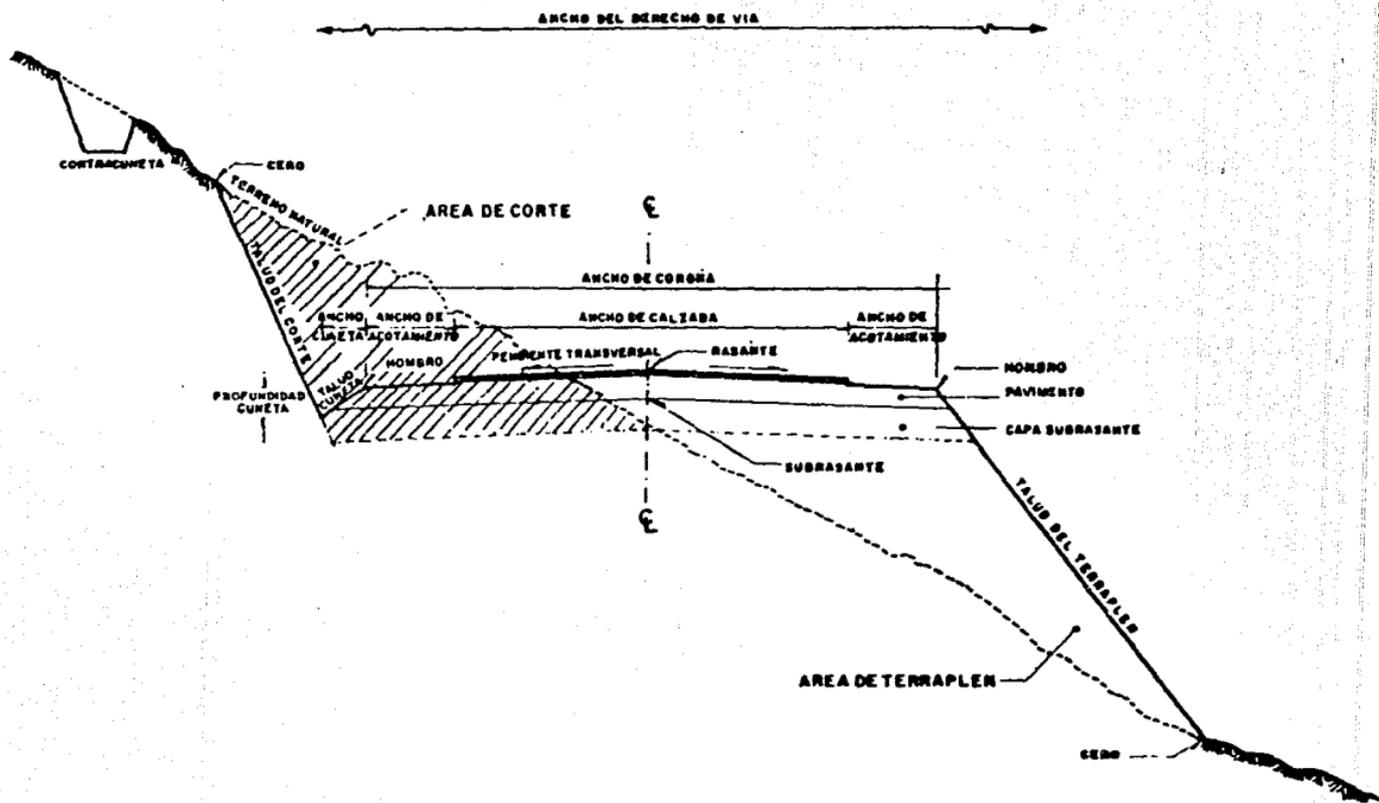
SECCION TRANSVERSAL TÍPICA EN UNA TANGENTE DEL ALINEAMIENTO HORIZONTAL
